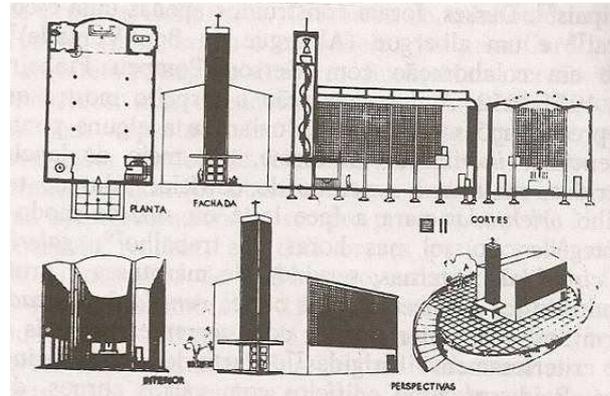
Igreja de Monlevade – Plantas, elevações e cortes
